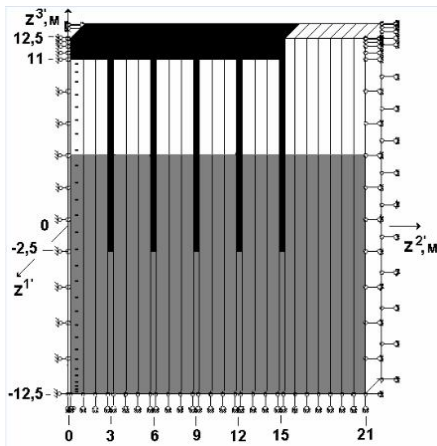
Дискретна модель НМСЕ для фрагмента фундаментної плити з одним рядом паль
